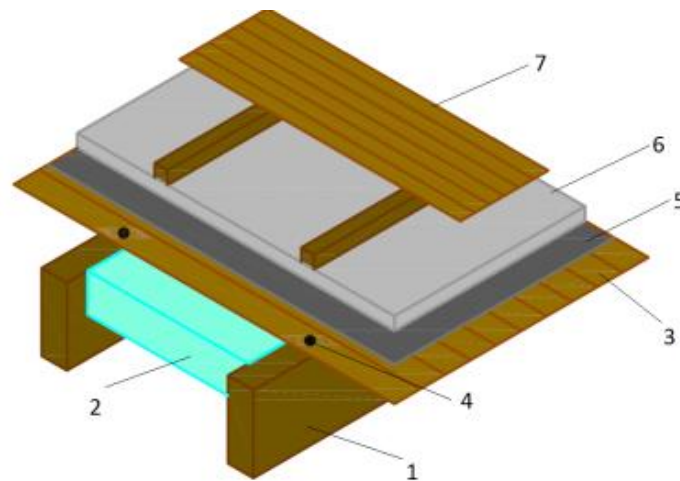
Tipologia típica de um pavimento misto madeira-betão. Legenda: 1. Viga de madeira; 2. Isolamento; 3. Soalho/cofragem; 4. Ligador; 5. Membrana impermeabilizante; 6. Laje de betão; 7. Revestimento de piso.
